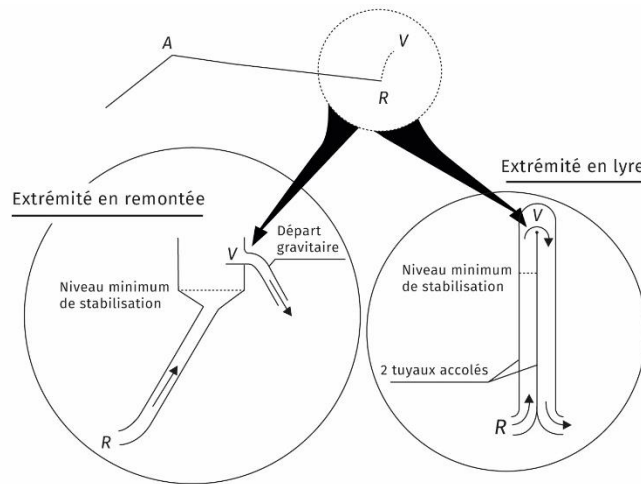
Raccordements d'une conduite de refoulement comportant un point haut sur une conduite gravitaire
